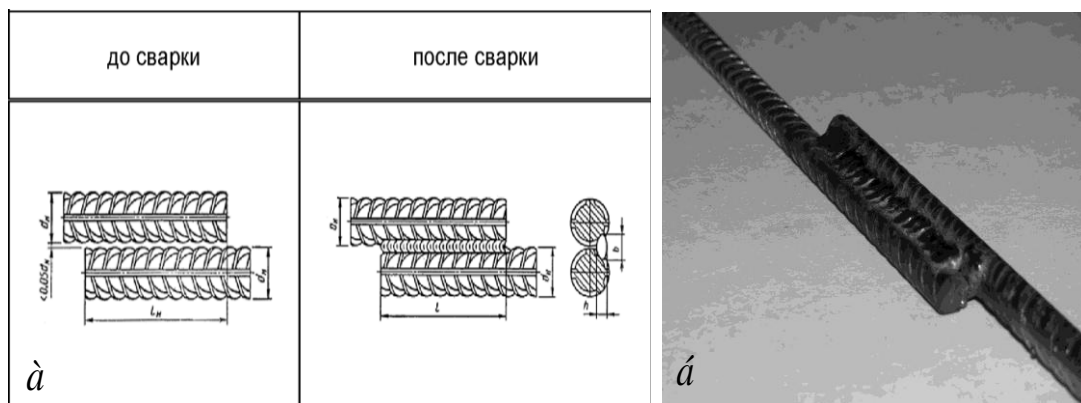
Сварное соединение арматурных стержней по ГОСТ 14098-2014 [6] (а); сварное соединение арматурных стержней класса S500, выполненное ручной дуговой сваркой (б)
